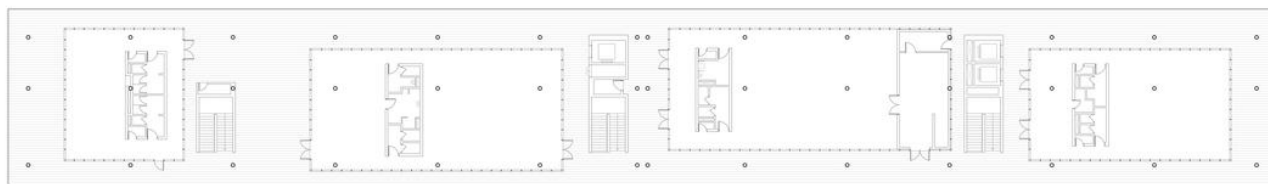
Planta Baixa Apartamento Tipo - Hotel CitizenM
